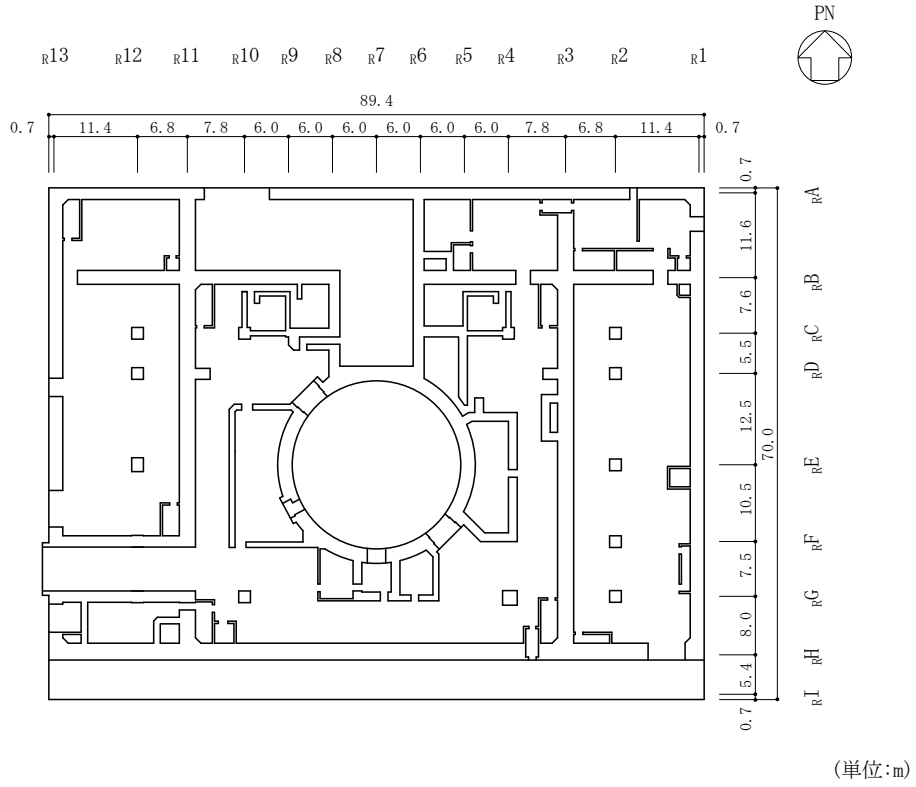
(3) 原子炉建物の概略平面図 (EL 15.3m)
